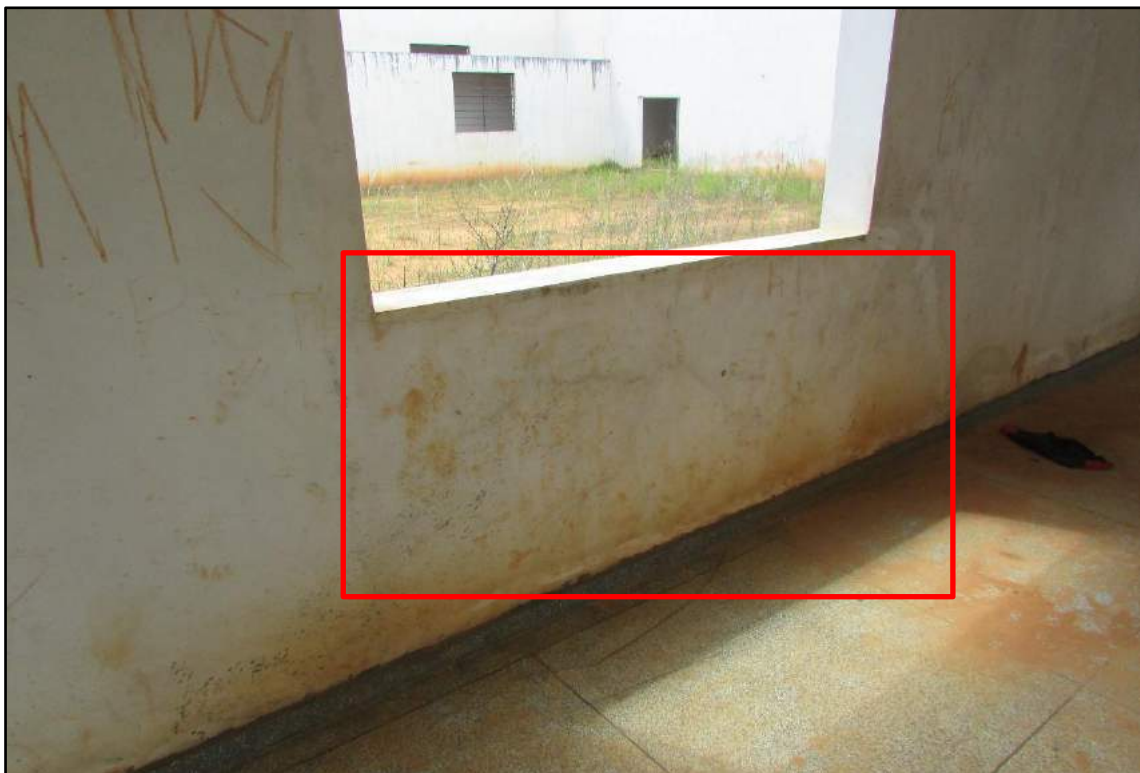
Fissuras mapeadas abaixo da abertura da janela. Ensaio de percussão sugeriu falha de aderência do revestimento.
